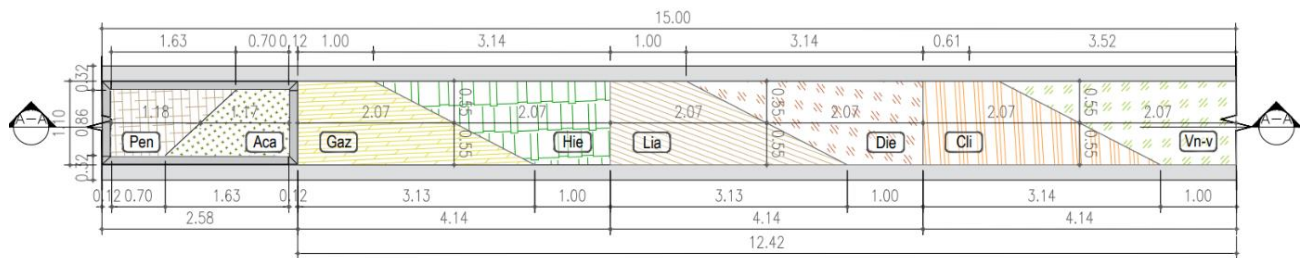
Detalle en planta de la jardinería de la FPM en estaciones.
